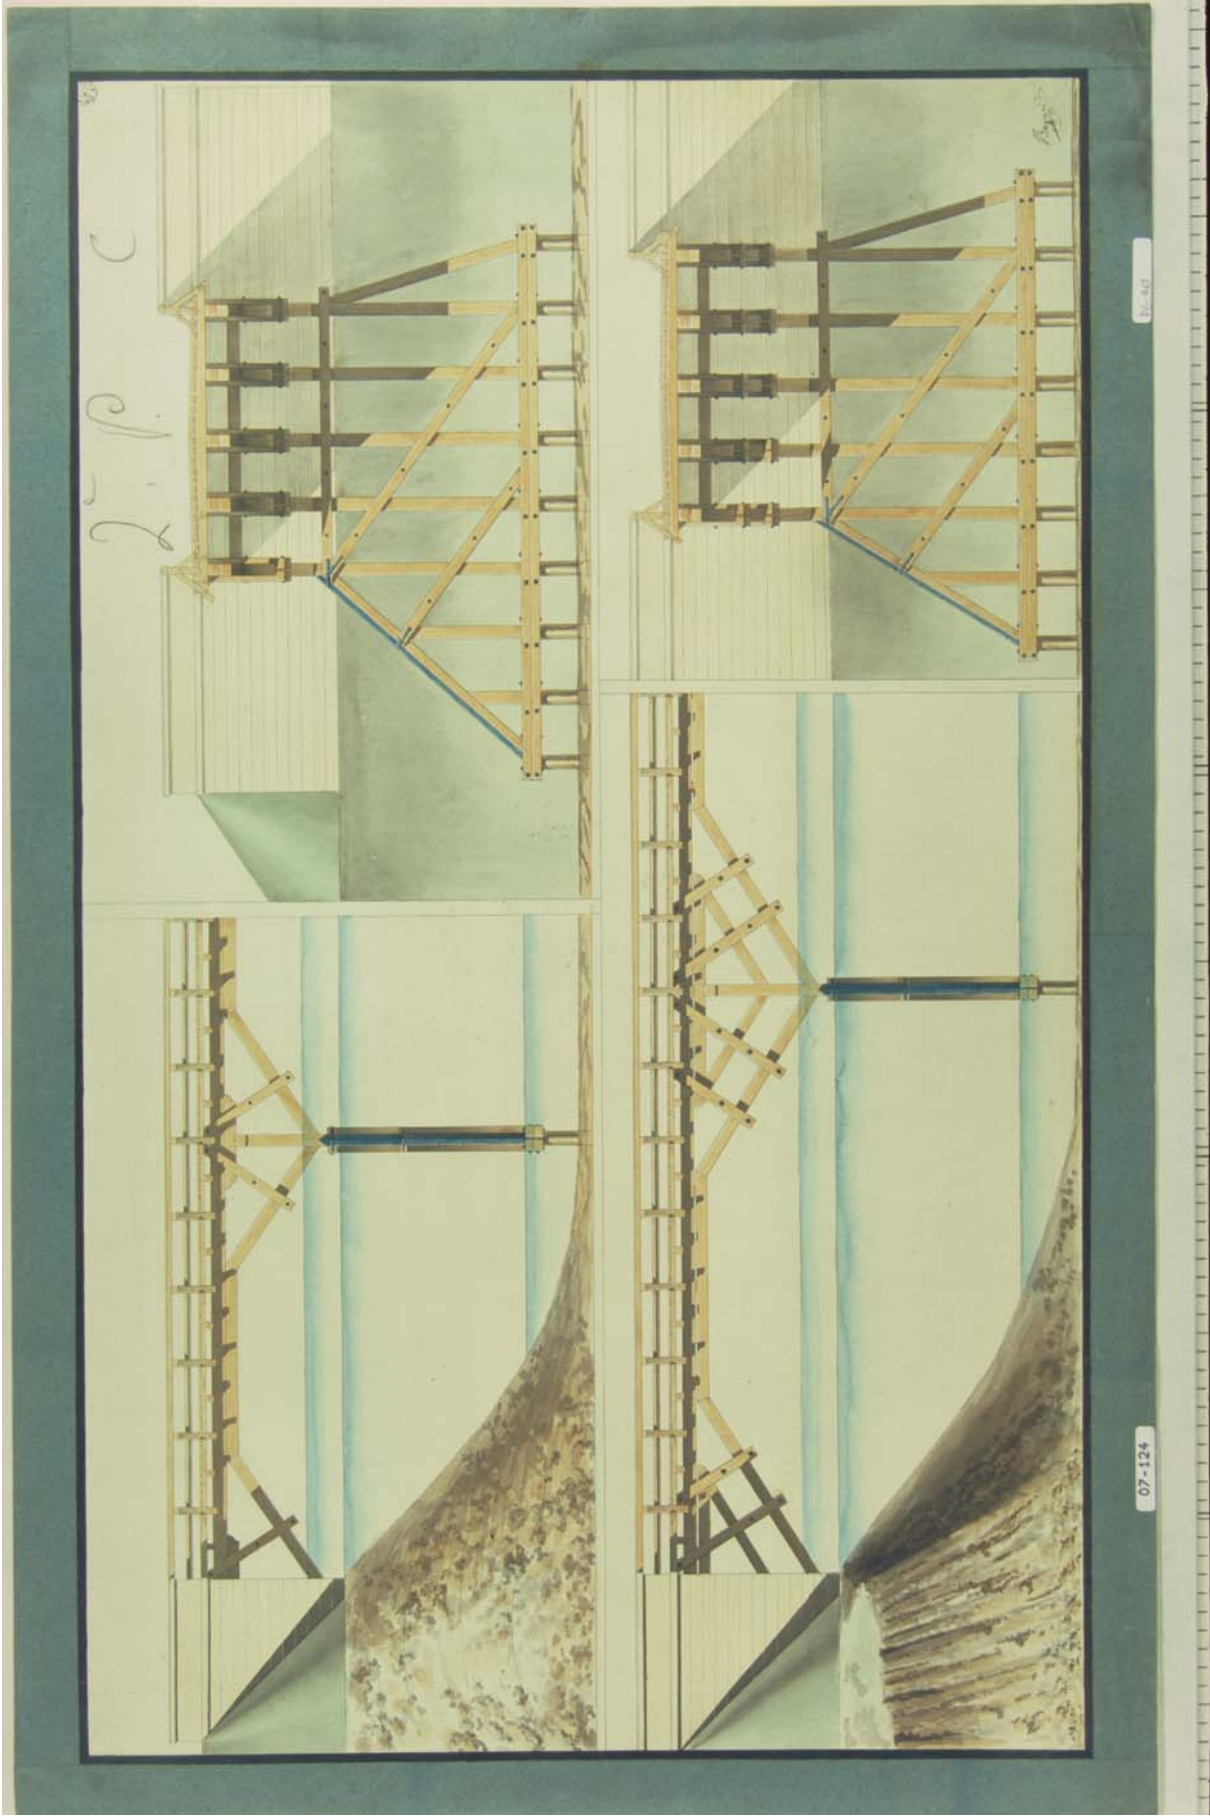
DG 461 – Ferdinand Jean Bayard de la Vingtrie. Concours pont. Pont en charpente. Elevation et coupes. 2^o premio. 1816
